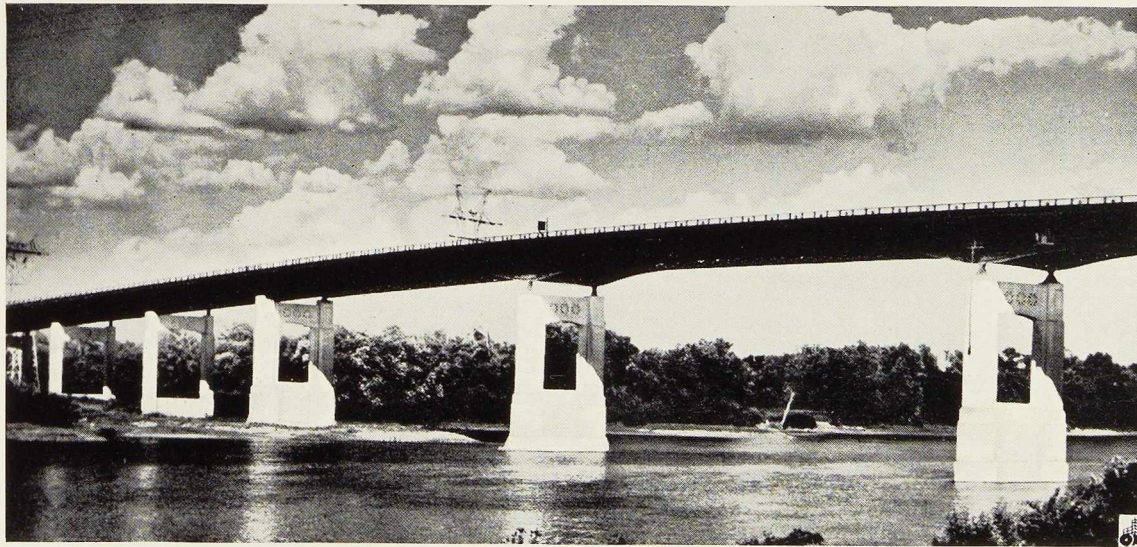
Pont Charter Oak sur le Connecticut River. La travée centrale de 91^m50 de portée est la plus longue travée en poutres à âme pleine en Amérique. Ingénieurs conseils : Robinson & Steinman. Constructeur : American Bridge Co.
